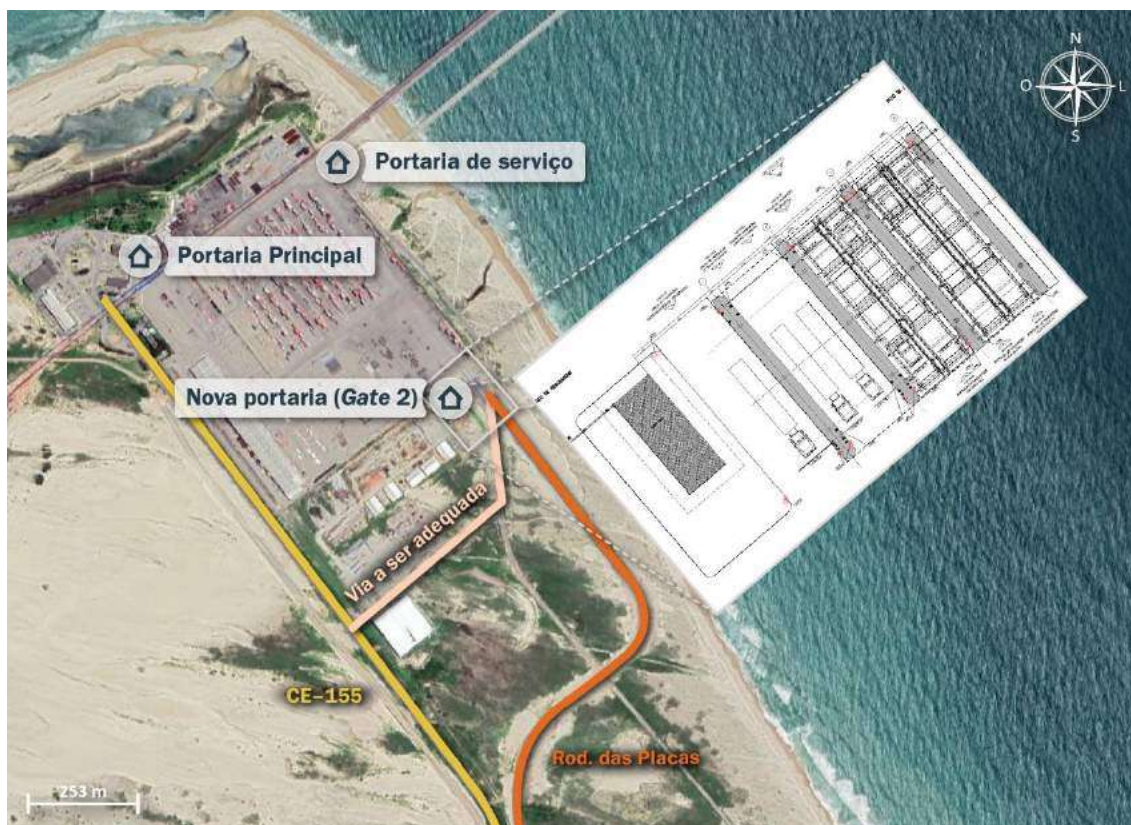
Localização e planta baixa da nova portaria (*Gate 2*) de acesso ao TPP
